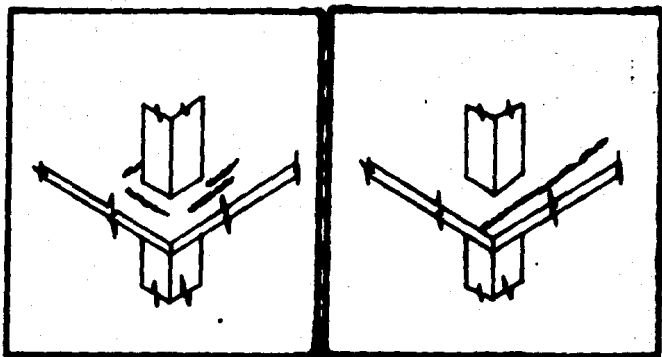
(4) Grietas por punzonación. FIG. 1.14 (4) Grietas longitudinales.
